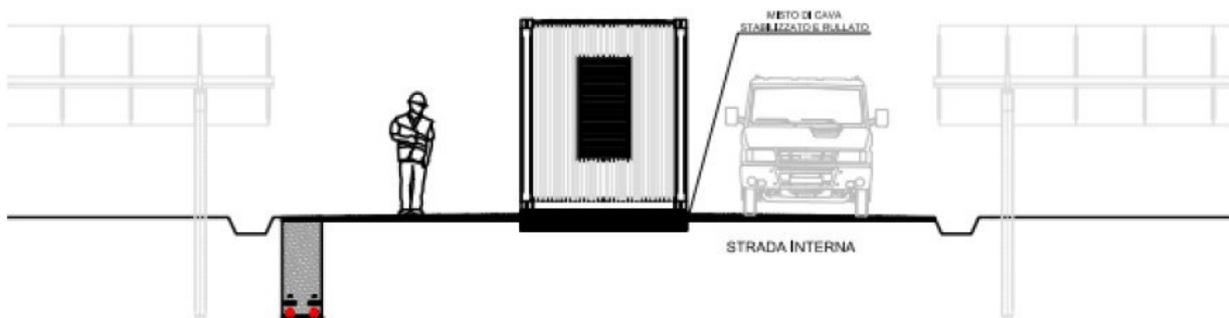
Viabilità di cantiere destinata ai mezzi pesanti
